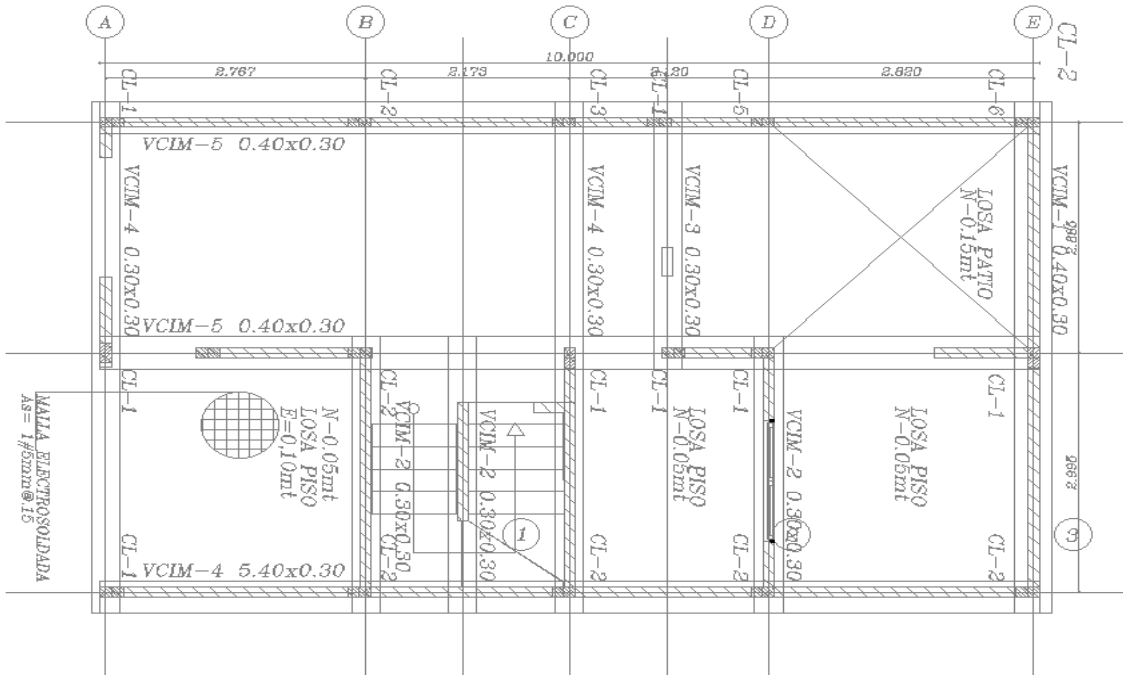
Diseño de cimentación de vivienda tipo- imagen de AutoCAD
